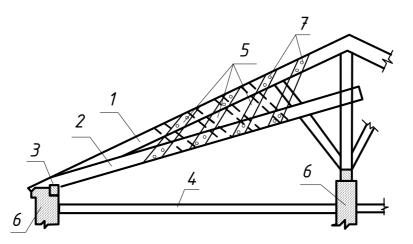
Устройство ферм с перекрестной решетчатой стенкой: 1 - усиливаемая деревянная стропильная нога; 2 - нижний пояс ферм; 3 — мауэрлат; 4 - чердачное перекрытие; 5 - решетчатая стенка из досок; 6 - кирпичные стены; 7 — гвозди
